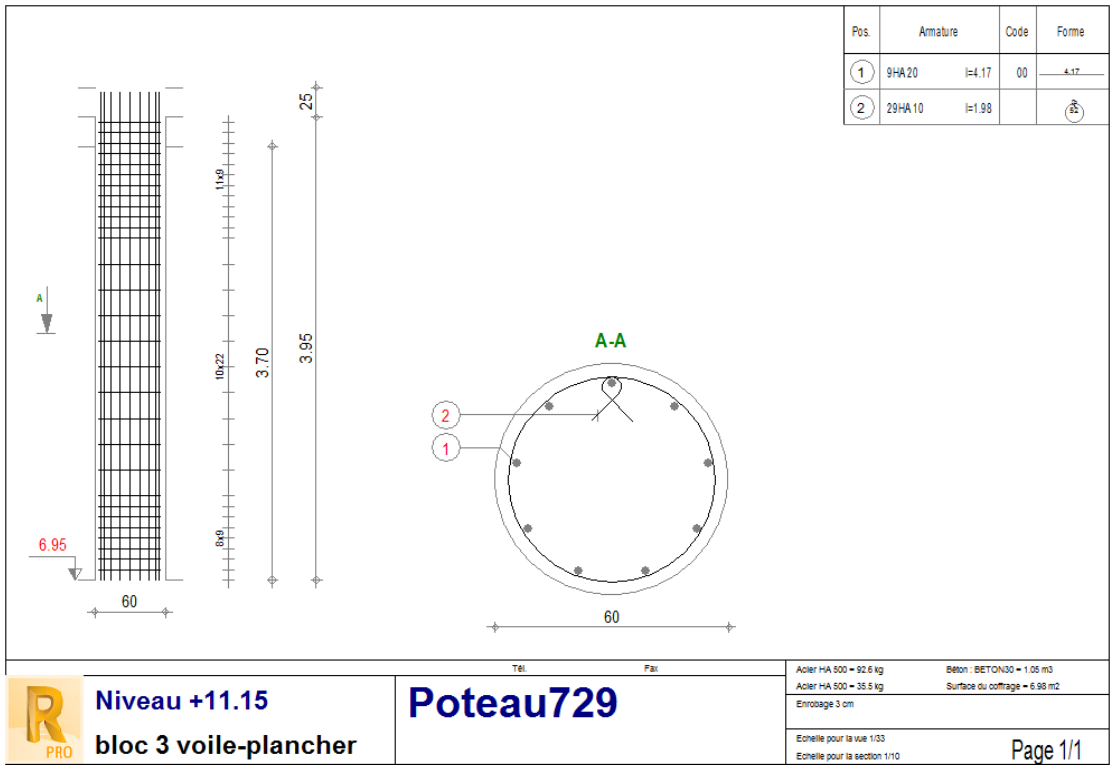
Ferrailage des poteaux P49, P50 et P51 (R-1)
